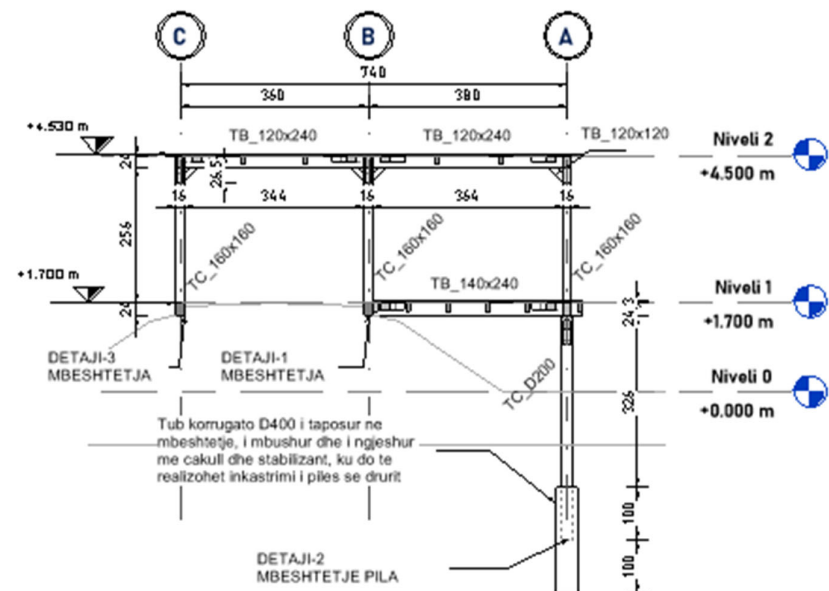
Planimetria e tendes, dhe prerjet kryesore.
